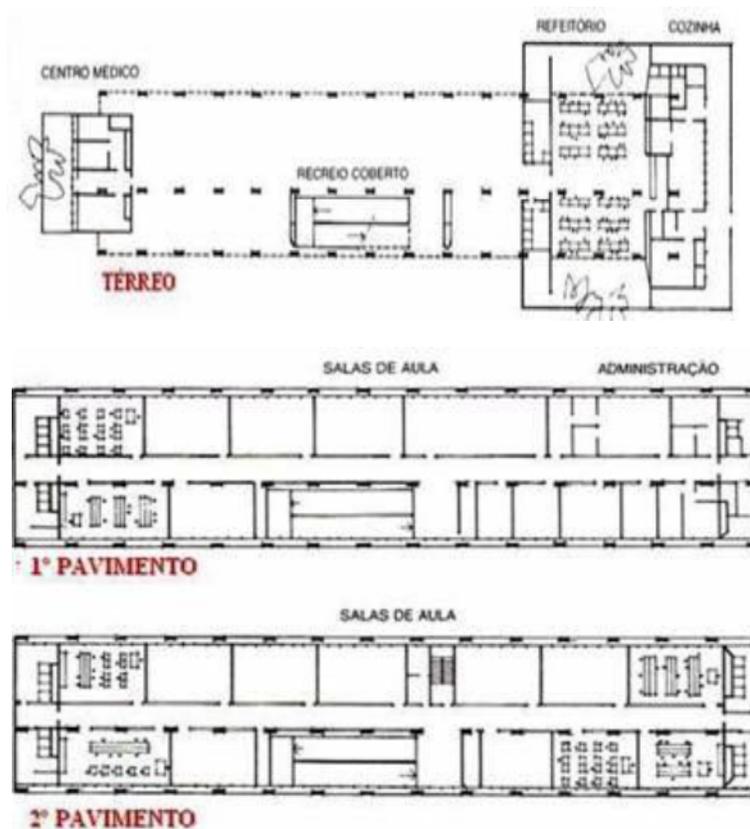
Plantas baixas do prédio principal - térreo, 1º e 2º pavimentos (Planta modelo).
